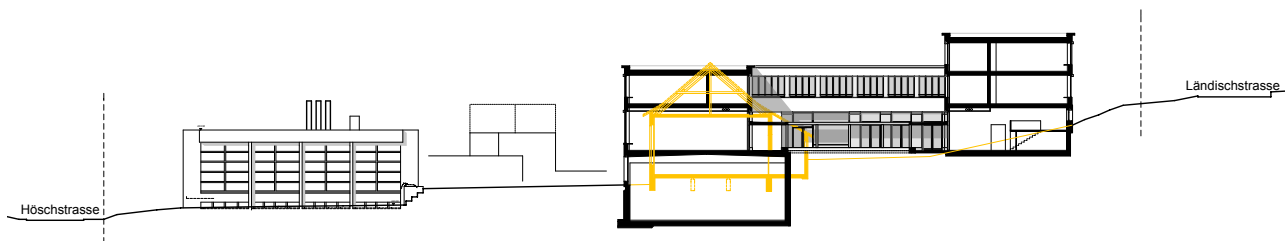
Schnitt durch Gebäude A mit neuer Turnhalle und Lehrerbereich sowie Ansicht an die alte Turnhalle (Planstand Bauprojekt 2014)
